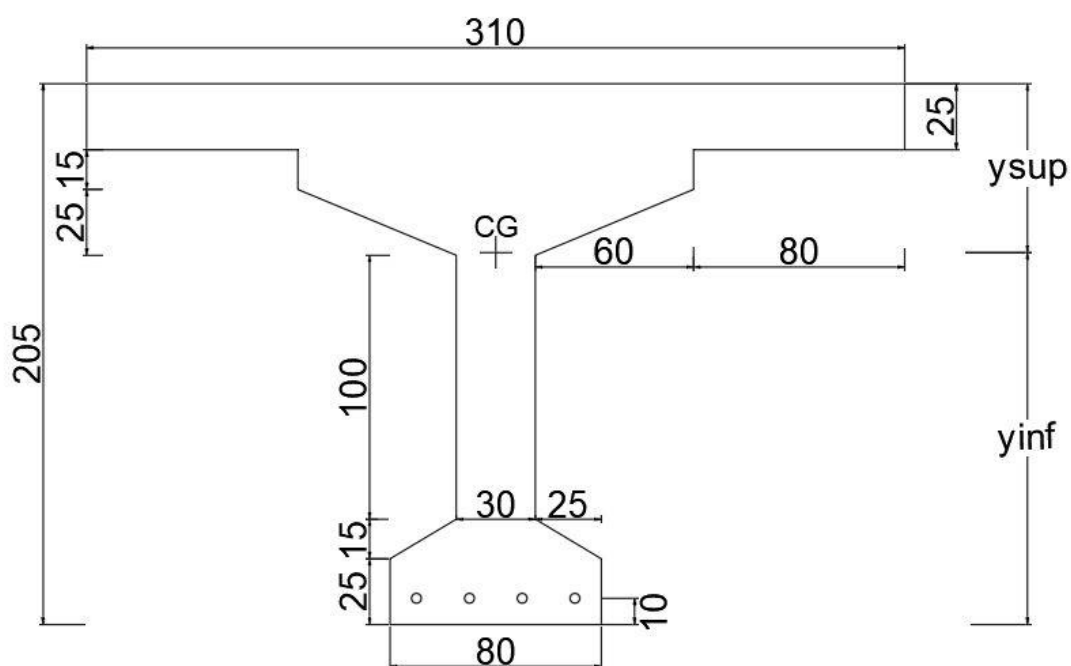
Seção viga de ponte (Elaborado pela autora, 2018)
